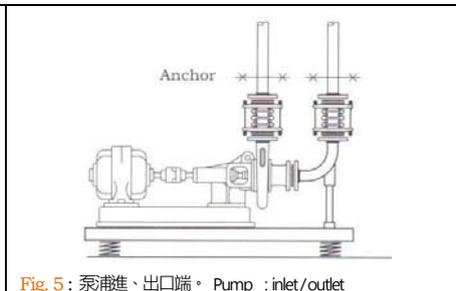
泵浦進、出口端。 Pump : inlet/outlet
